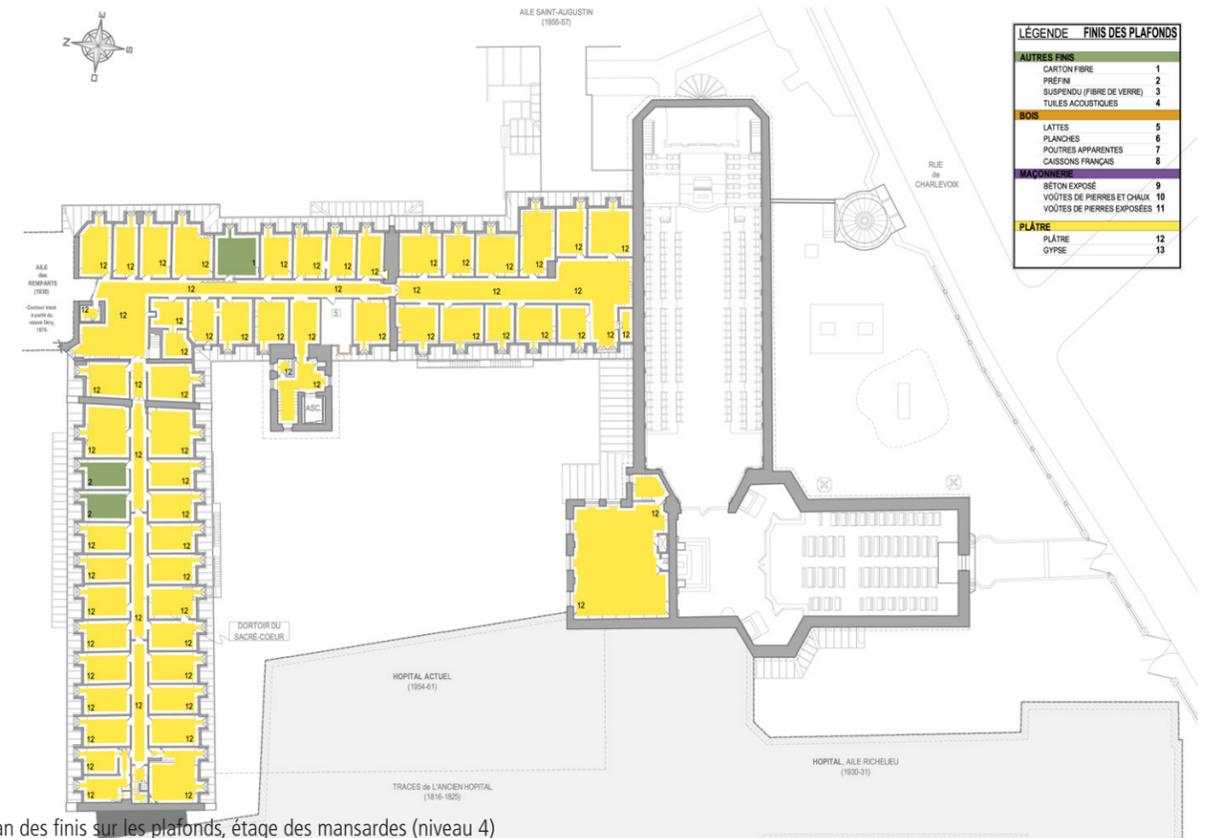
Plan des finis sur les plafonds, étage des mansardes (niveau 4)
